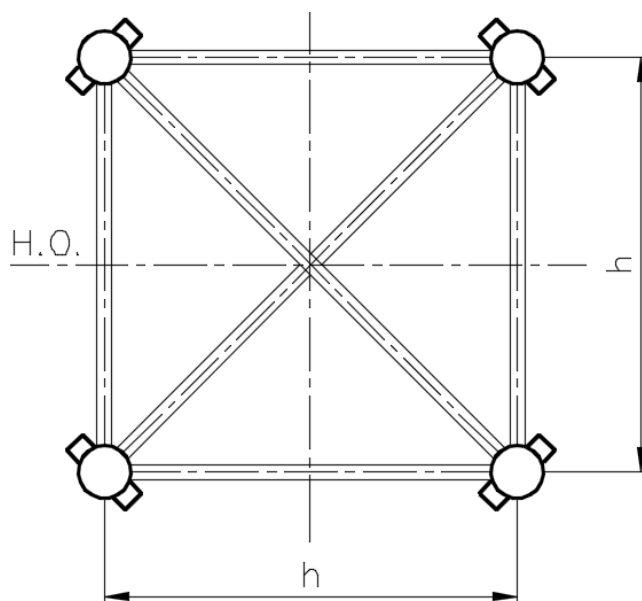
Схема поперечного сечения четырехгранной ферменной опорной колоны с цилиндрическими рейками A1
